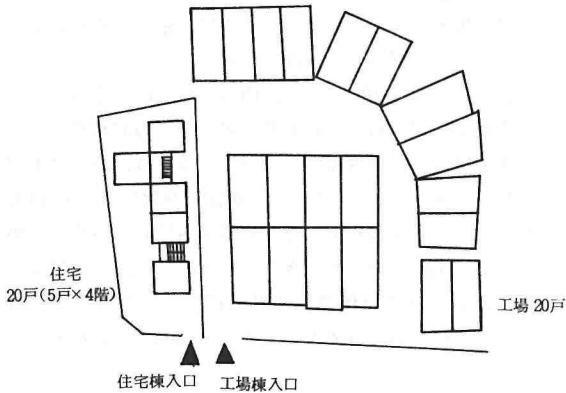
美原木工団地内小規模事業配置図(工場棟、住宅棟)
